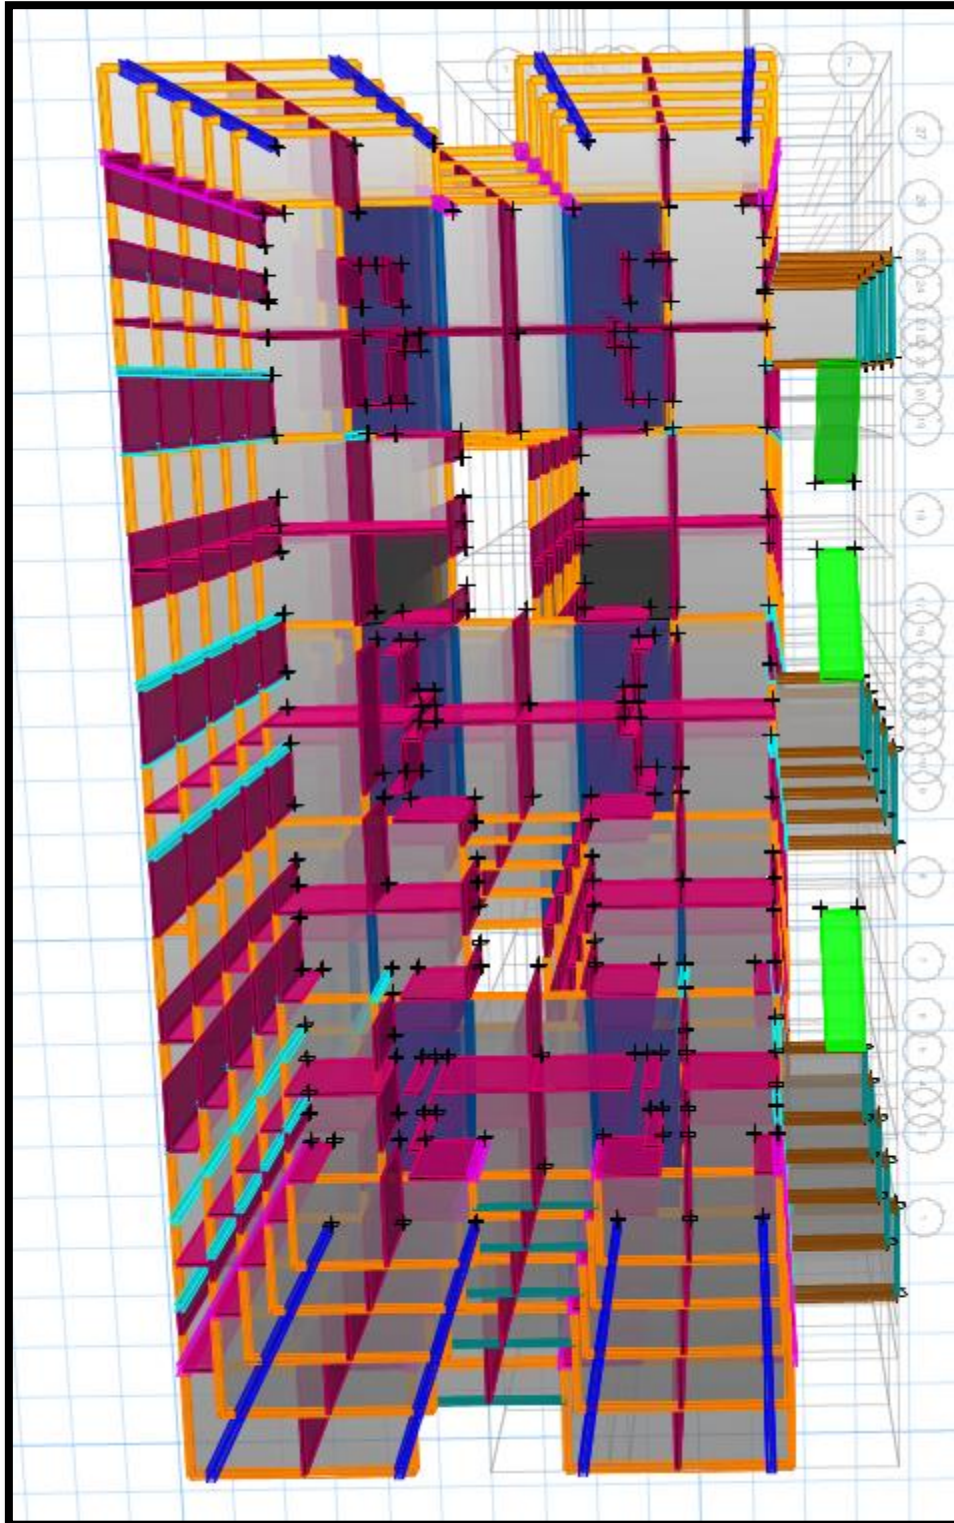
Vista de Vigas y Muros de Ductilidad Limitada
